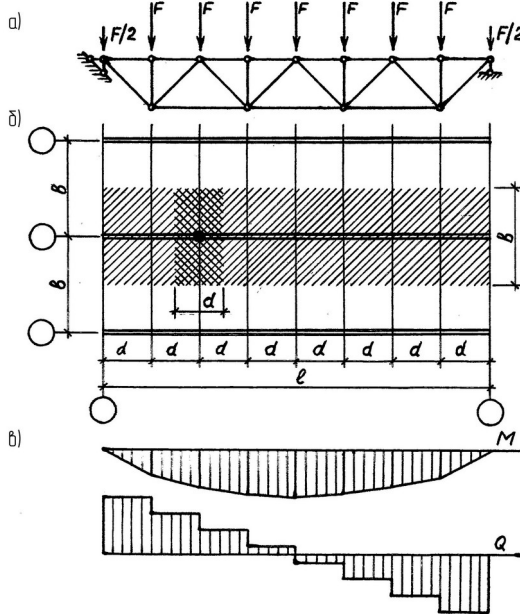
Расчетная схема фермы (а), определение узловых и погонных нагрузок (б), эпюры изгибающих моментов и поперечных сил (в).
